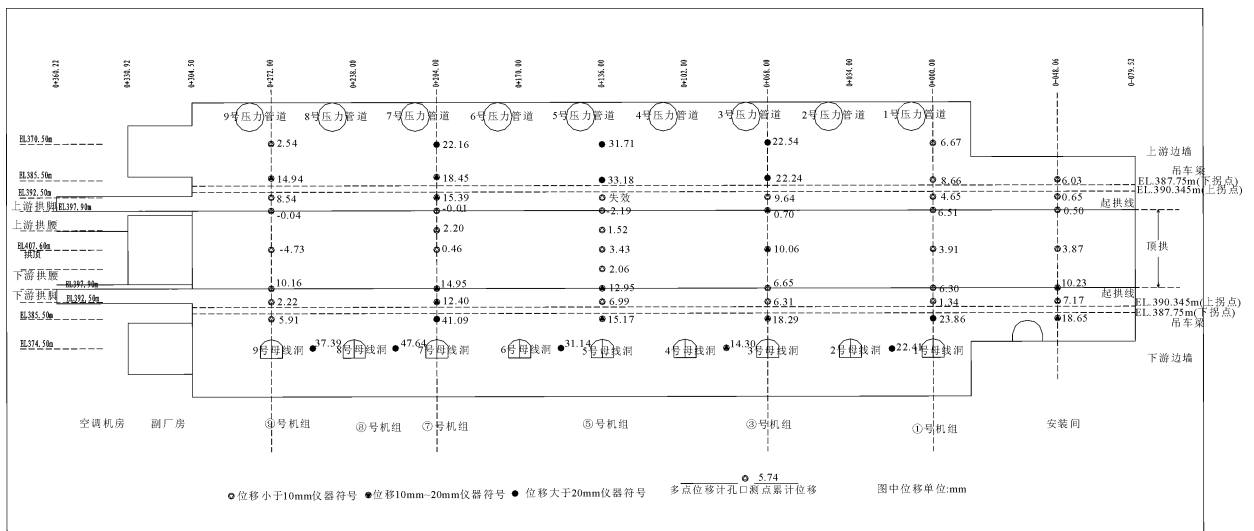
左岸主厂房仪器布置平面图(围岩表面位移平面布置图)
